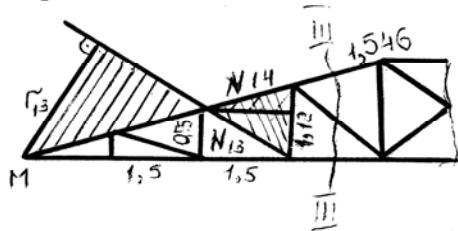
Схема к расчету усилий в стержнях 14 и 13
